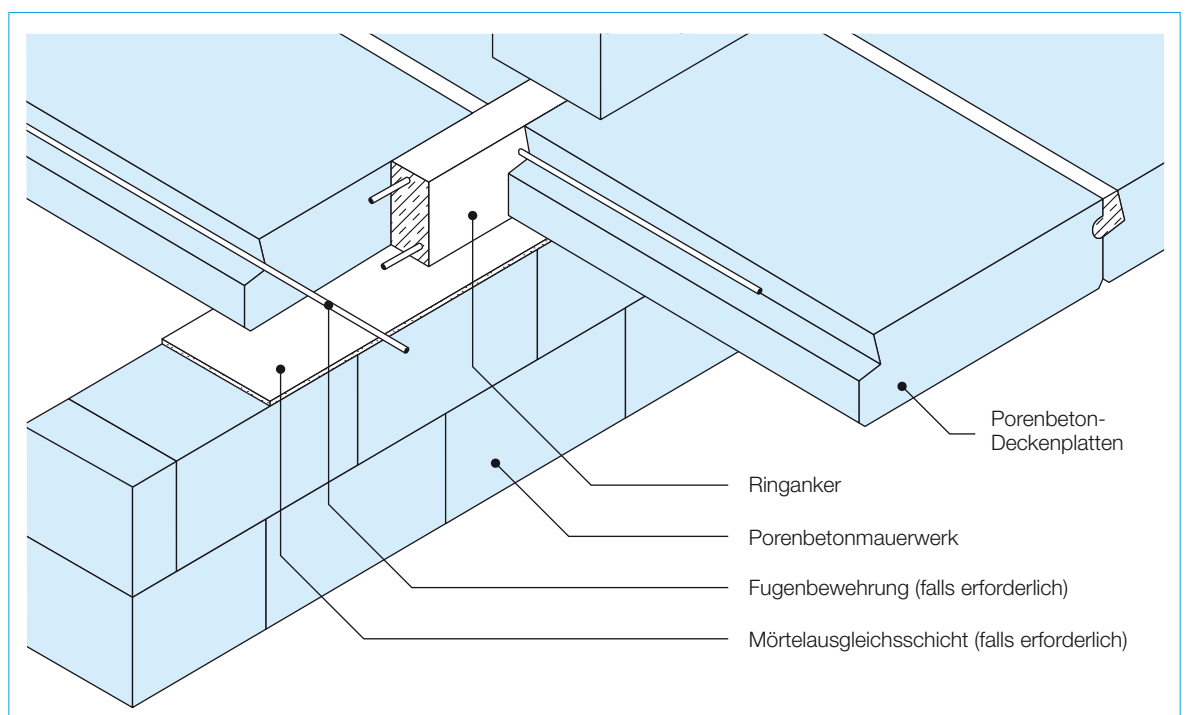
Zwischenauflagerung von Porenbeton-Deckenplatten auf tragender Innenwand aus Porenbetonmauerwerk, Ringanker in Dachplattenebene
